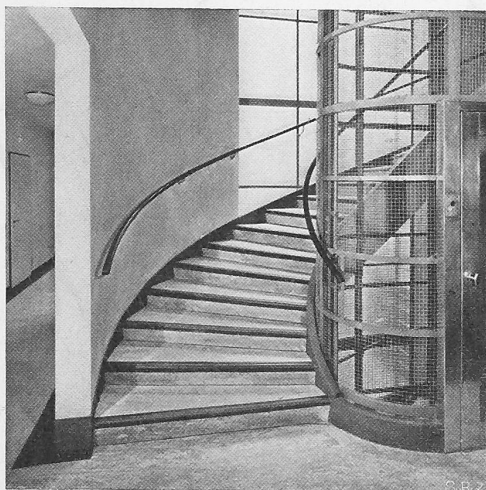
Treppenhaus und Gang in den Obergeschossen.
